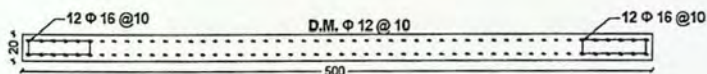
Sección transversal Muros 1 y 2, Edificio A
